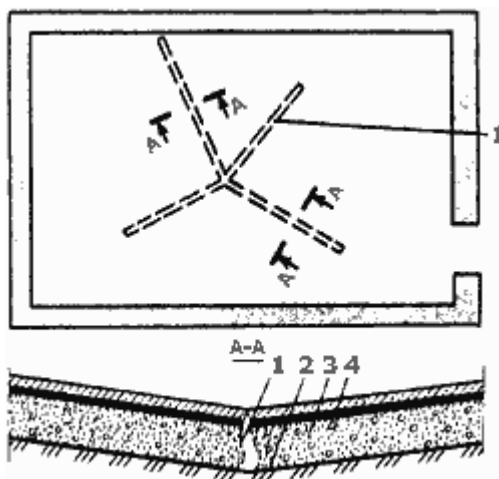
Разрушенный бетонный пол: 1 - трещина в бетонном полу; 2 - просевший грунт; 3 - бетонная подготовка; 4 - гидроизоляционный слой.
